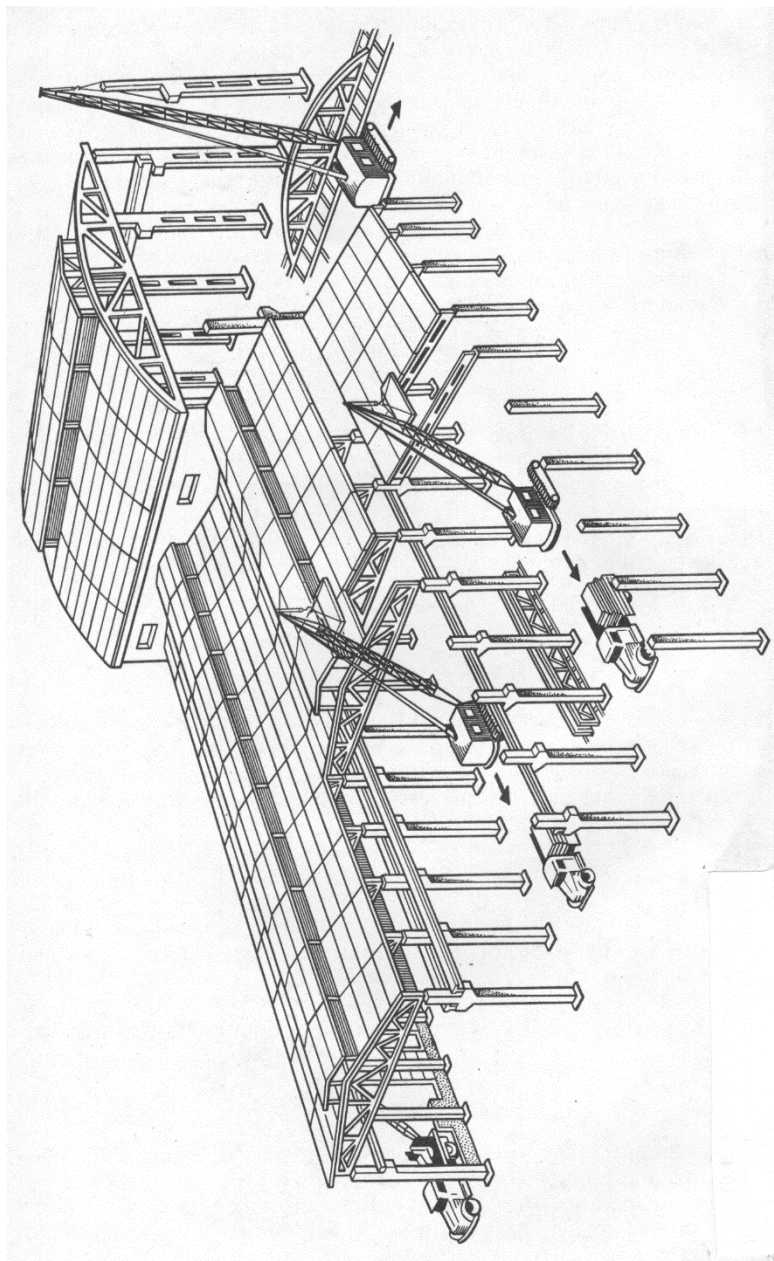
Монтаж одноэтажного промышленного здания специализированными потоками
